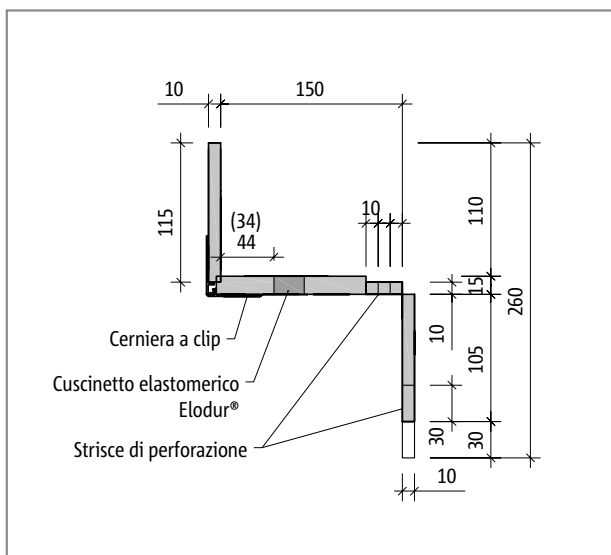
Schöck Tronsole® tipo F-V1, (-V2), sezione dell'elemento in caso di modifica della profondità massima della mensola
